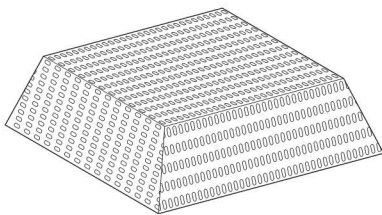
Gitterrost für Geberit Pluvia Dachwassereinlauf
